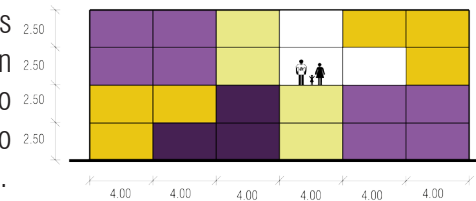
Elevación esquemática de torre con el juego de fachada de las tipologías y los vanos.
